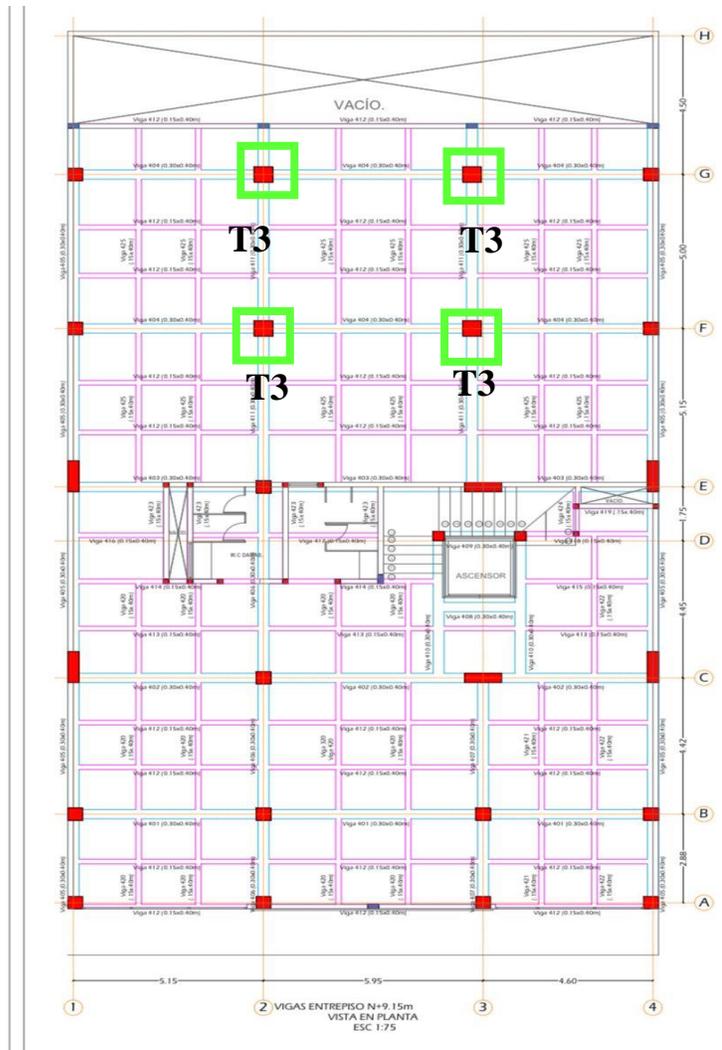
Vigas, columnas y columnetas vista en planta.
